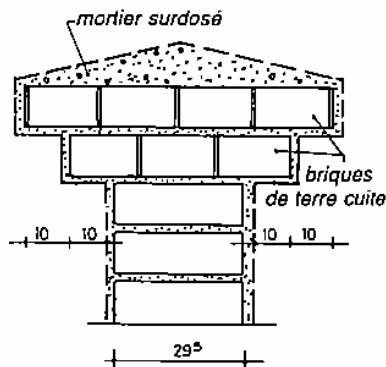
Détail de la corniche d'acrotère avec son encorbellement en briques cuites.
